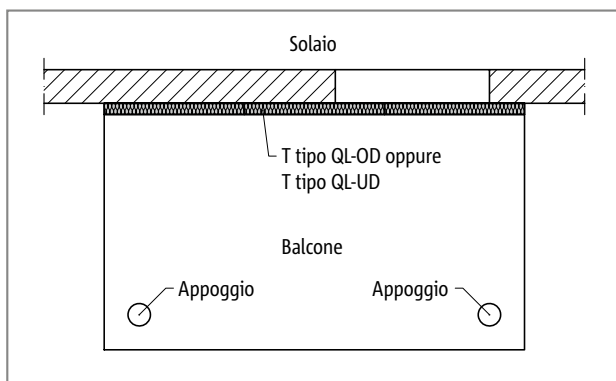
Schöck Isokorb® T tipo QL-OD/QL-UD: balcone appoggiato su pilastri
